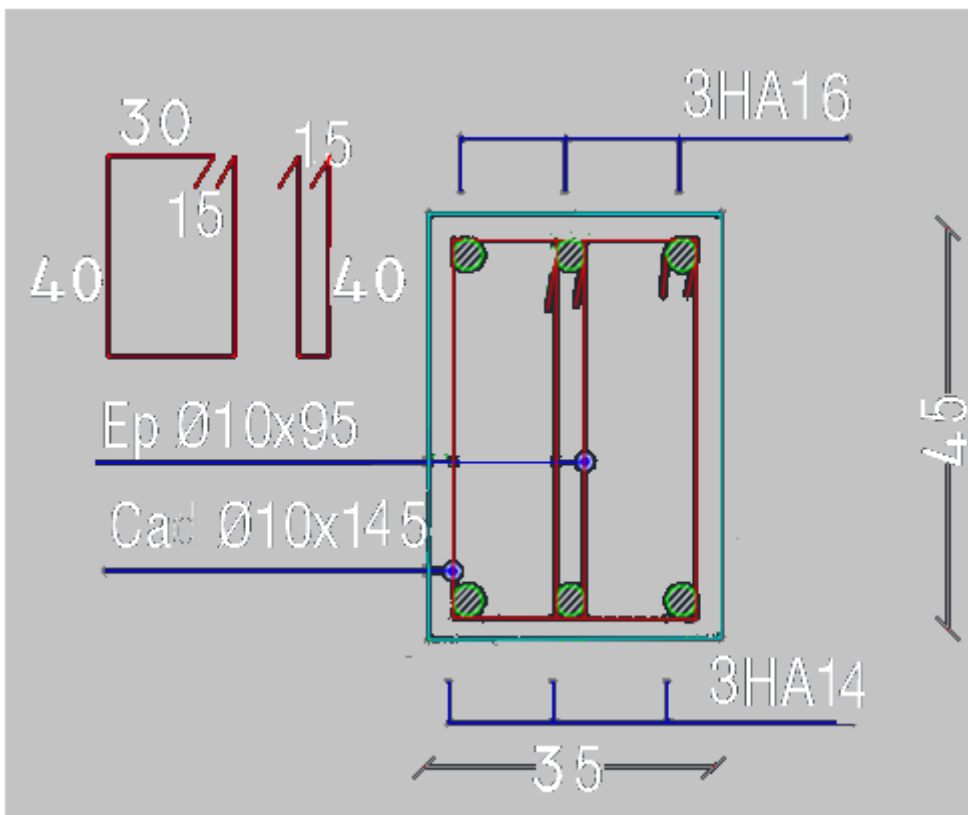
Ferrailage des poutres principales au niveau de travée de 2<sup>ème</sup> à 7<sup>ème</sup> étage.
